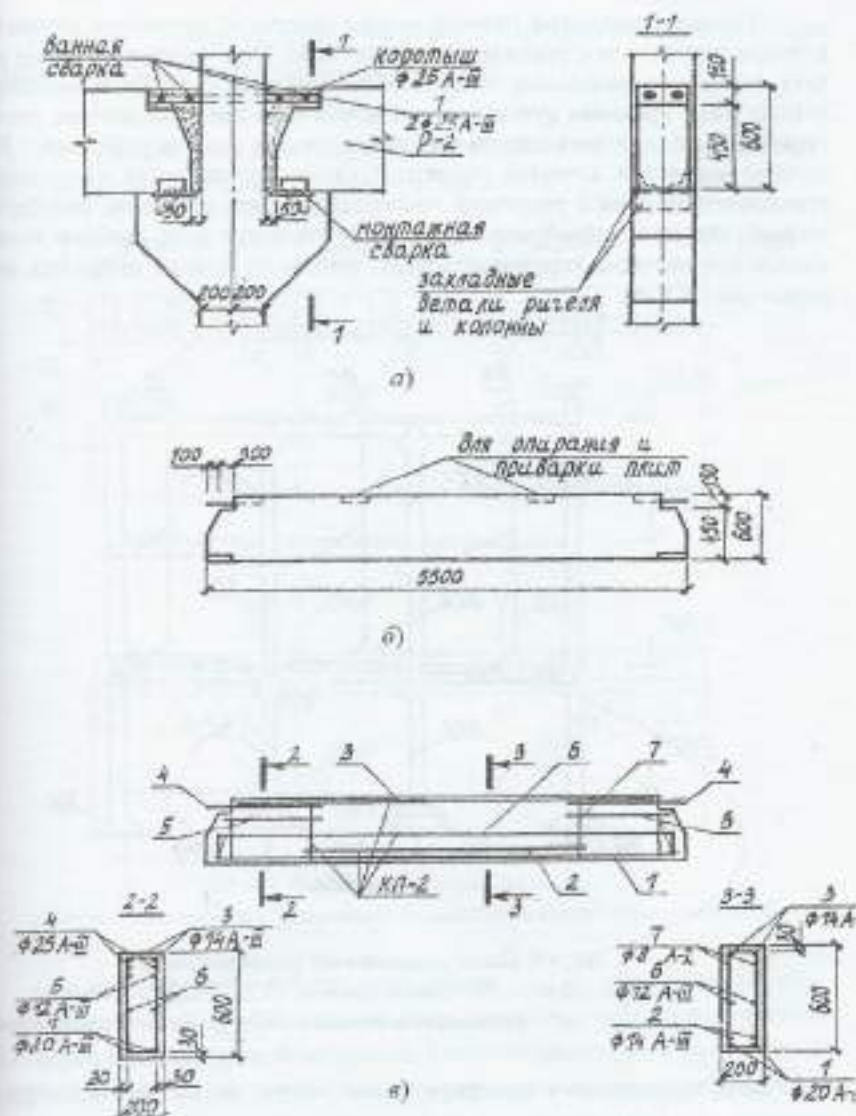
Конструкция ригеля Р-2 и стыка ригелей с колонной: а - сопряжение ригелей с колонной; б - опалубочный чертеж ригеля Р-2; в - схемы армирования ригеля Р-2.
